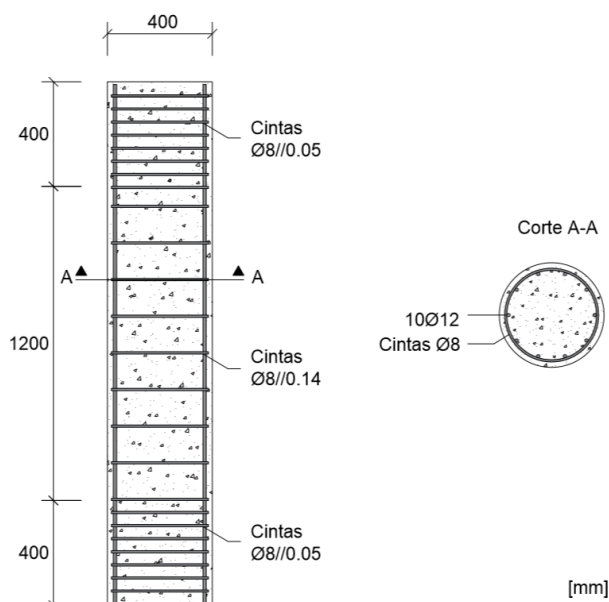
Pormenorização longitudinal e transversal das colunas (adaptado de *Matthys* [37])
